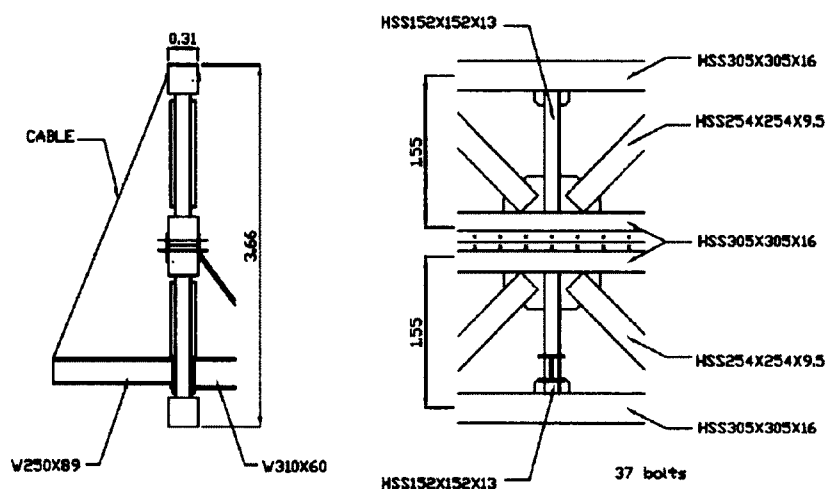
Pont à treillis latéraux - Section et élévation - Possibilité no.1
